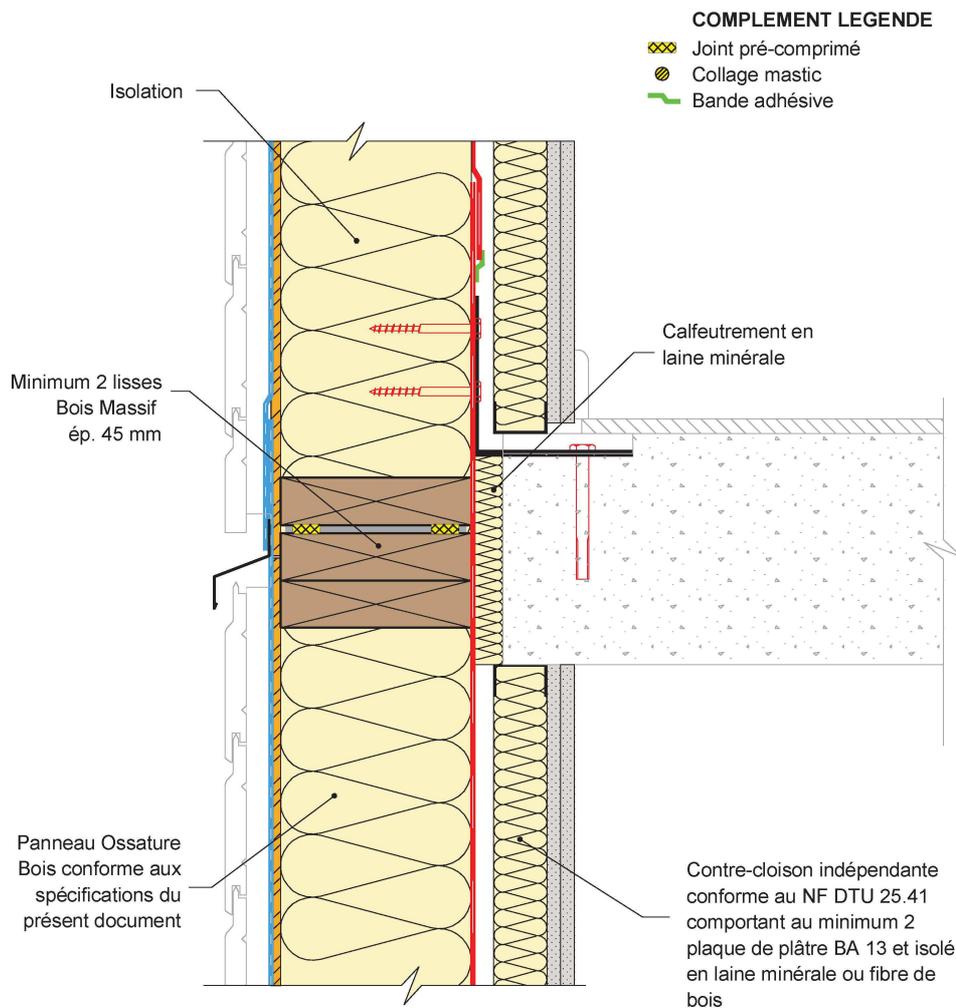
Coupe verticale d'une liaison plancher / façade filante
